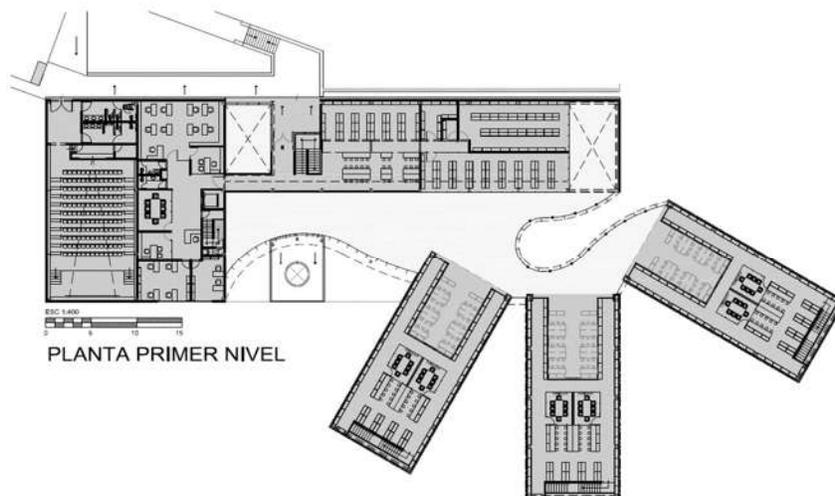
17 Planta Alta, La Biblioteca Central UAEM
